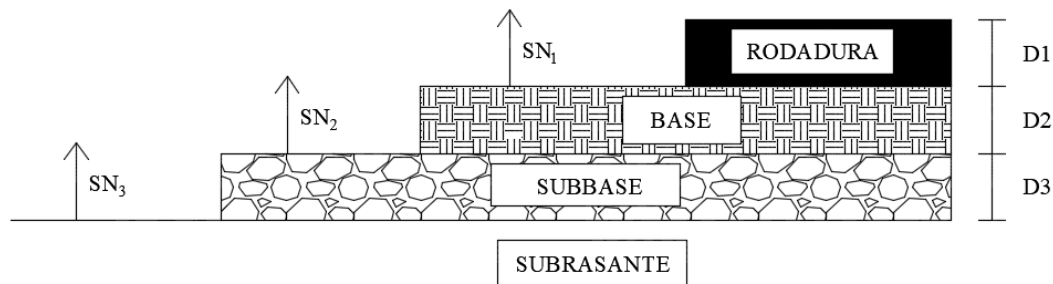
Paquete estructural de pavimento flexible. Fuente: Autor.
